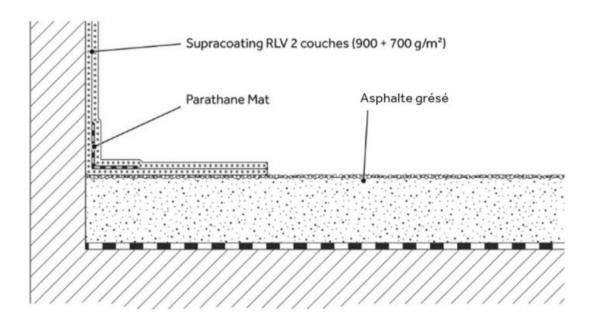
Mise en œuvre de Supracoating RLV dans le cas des étanchéités mixte uniquement en toiture inaccessible
